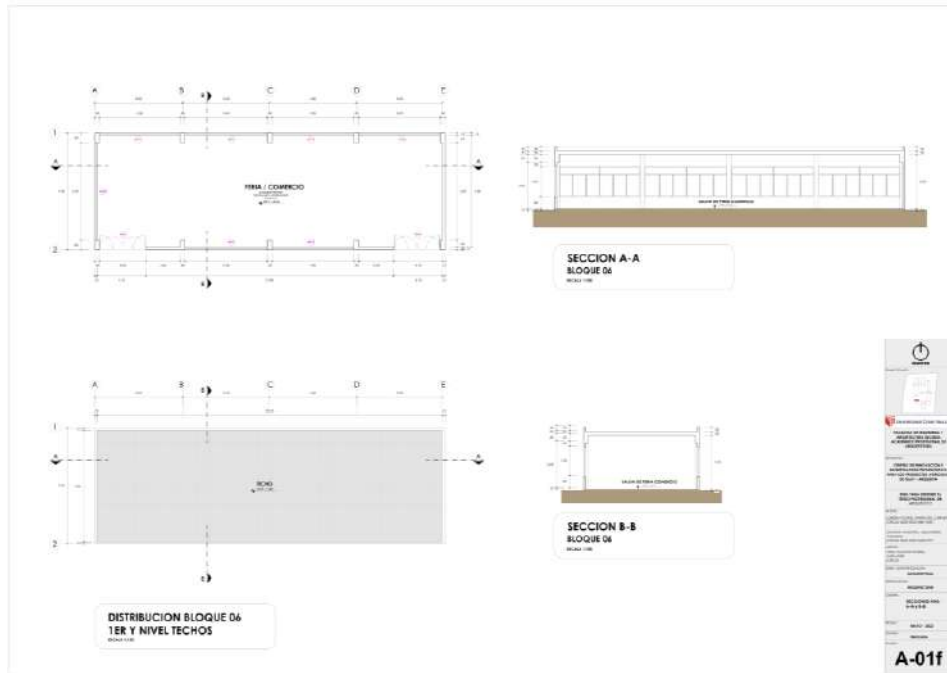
Plano De Distribucion Bloque 06 – Primer Nivel , Techos Y Secciones.
